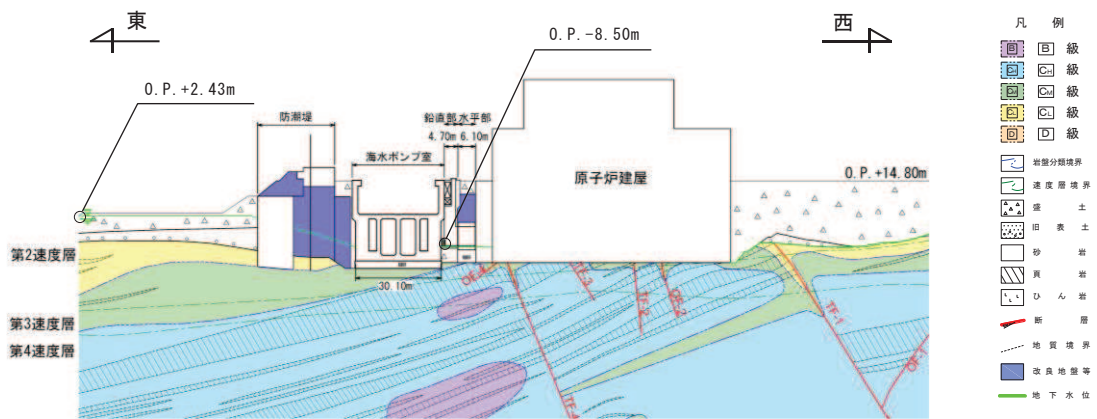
地盤改良範囲(縦断図, ②-②断面)
